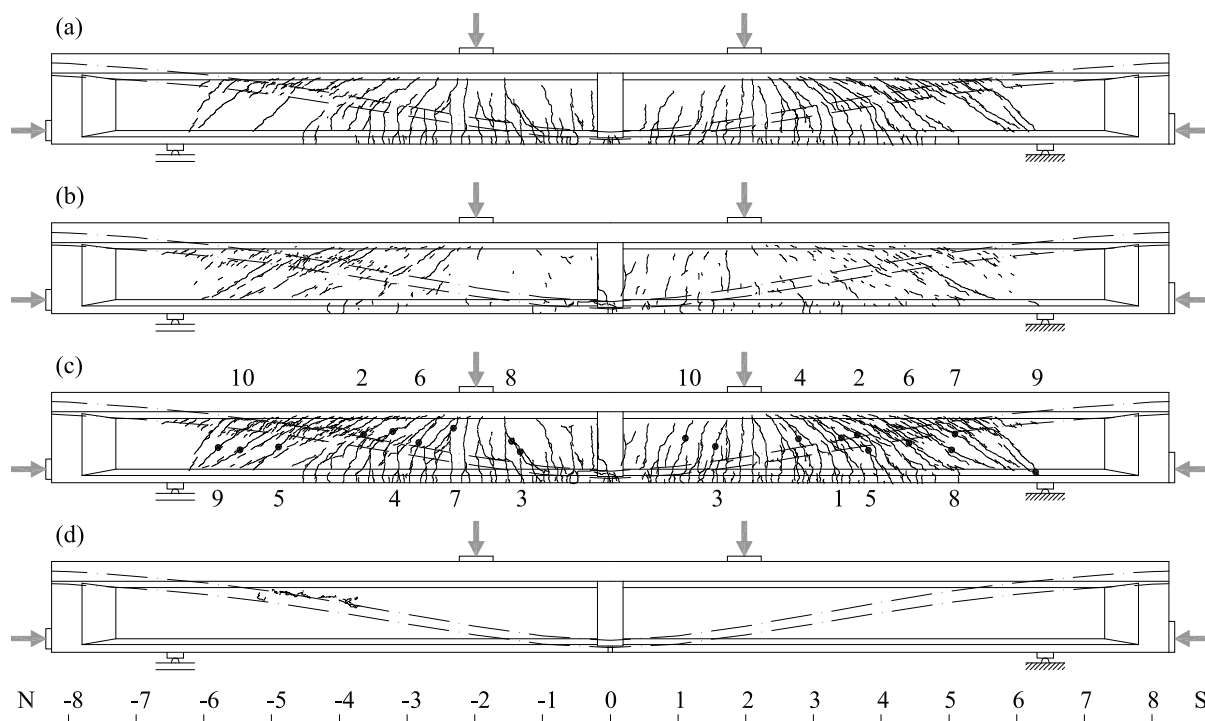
Fissuration de l'essai SH2 : (a) palier 3 (b) fissuration additionnelle entre le palier 3 et la rupture (c) rupture (d) éclatement du béton immédiatement après la rupture
